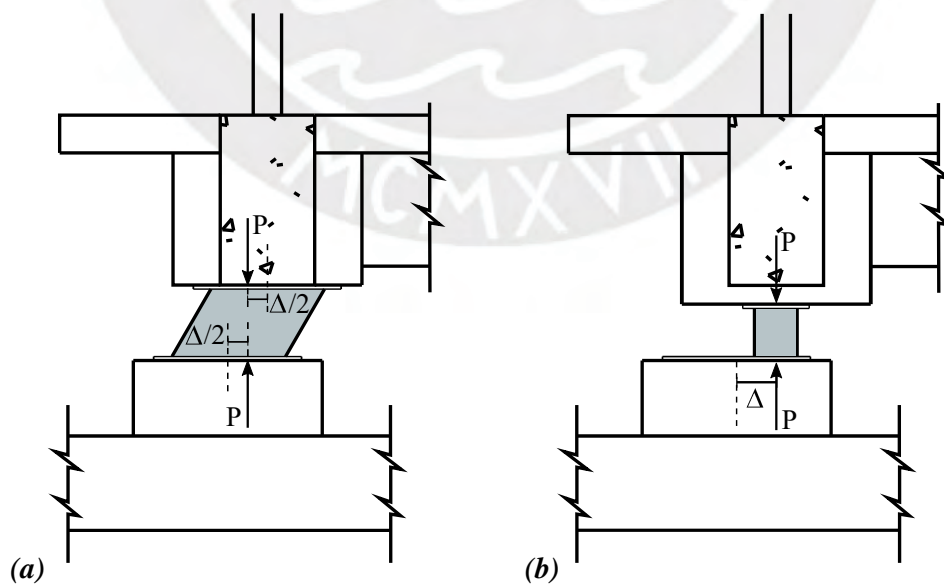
Efecto P-Delta en los dos tipos de dispositivos de aislamiento que se utilizan: (a) aislador elastomérico; (b) deslizador friccional plano.
